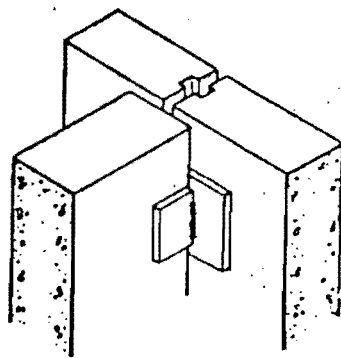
Conexiones verticales soldadas o atornilladas (ref 8)
